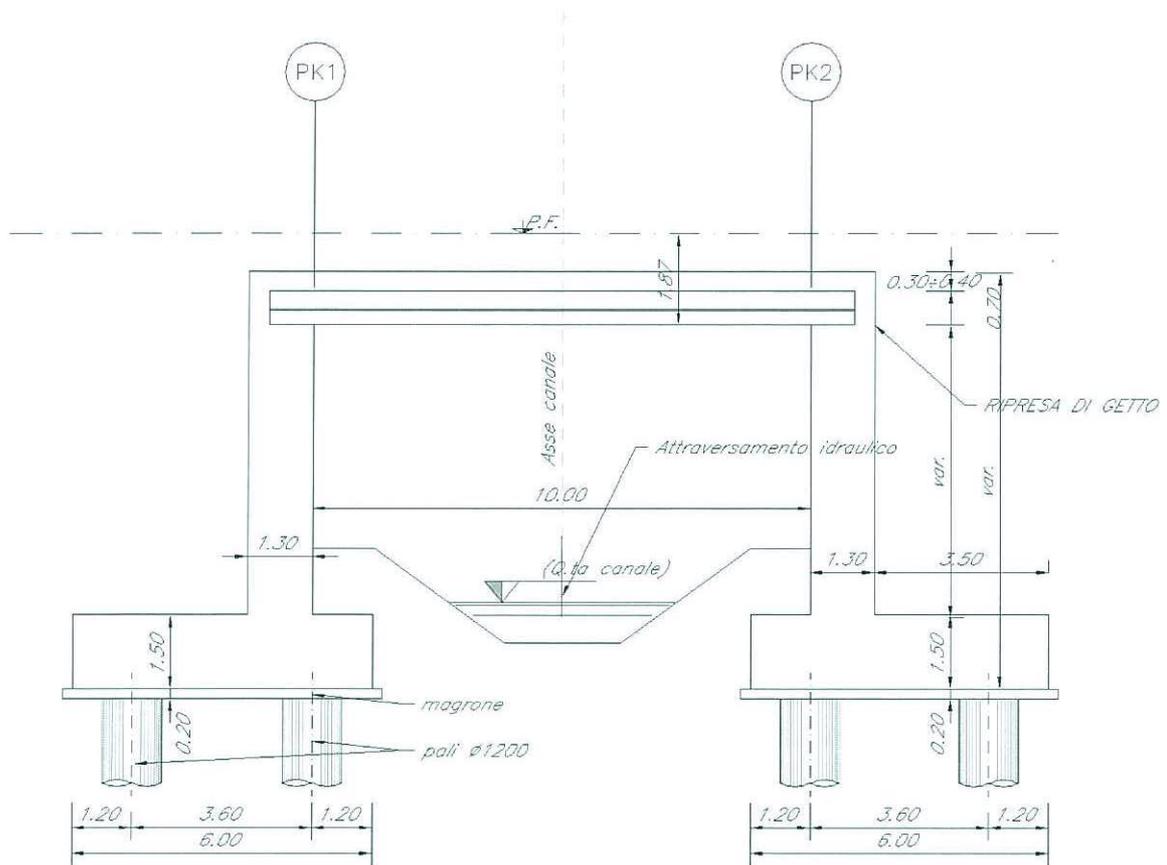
Prospetto in corrispondenza di attraversamento idraulico.
